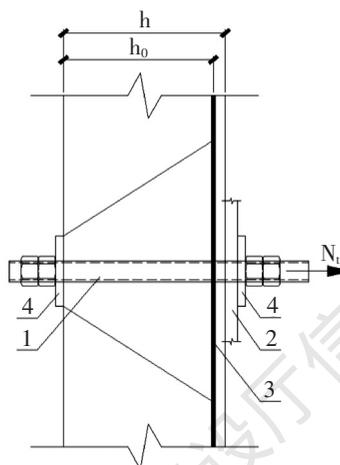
穿墙螺栓处混凝土受冲切状况图
